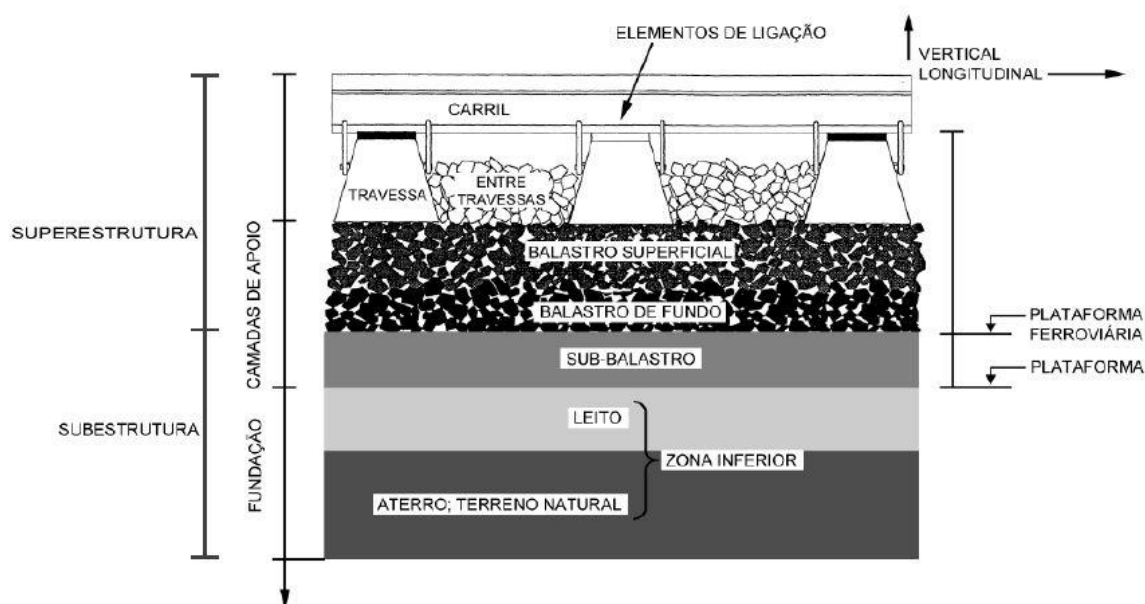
Esquema da superestrutura e infraestrutura (Adaptado de: (8))
